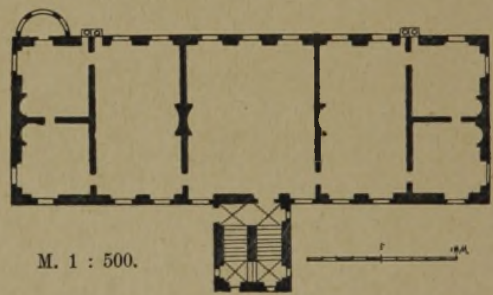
u. 3. Grundrisse zum Um- und Neubau gez. 1662. (M. 1 : 500.)
